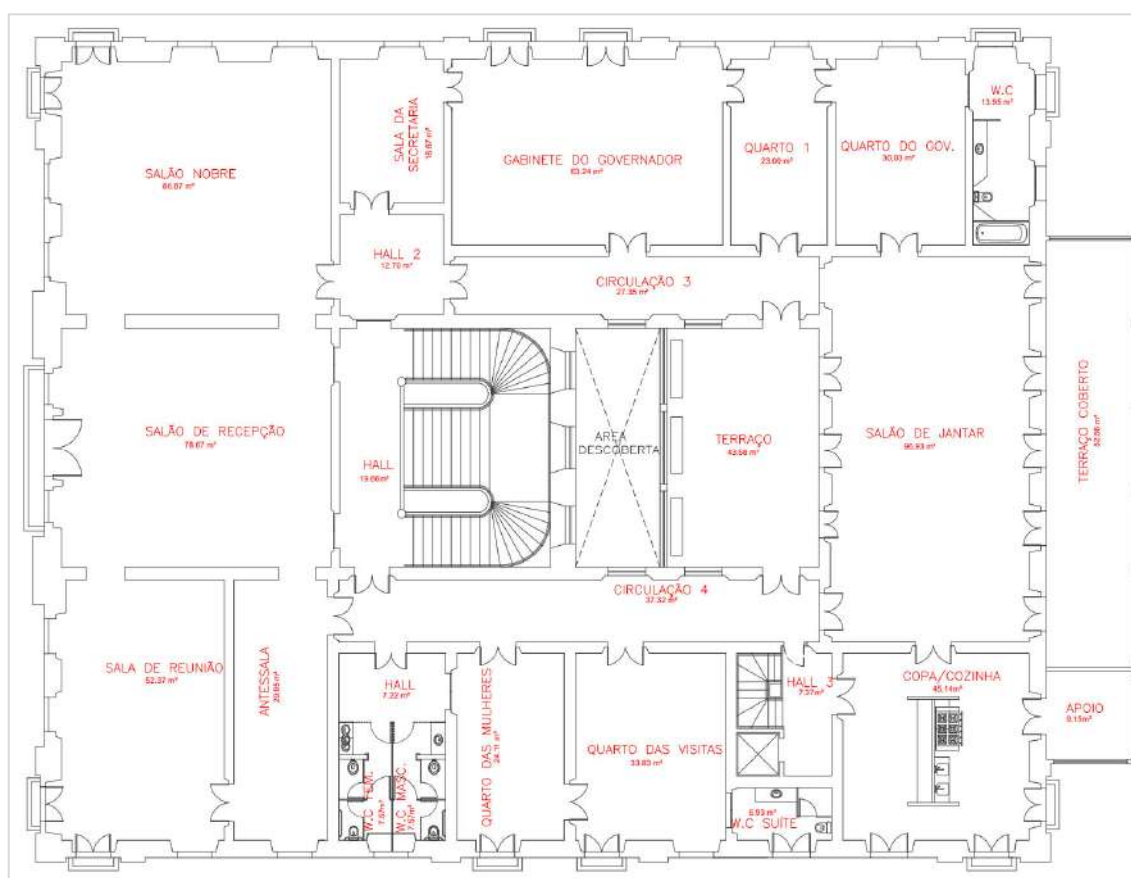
Planta baixa do pavimento superior do Palácio-Museu Olímpio Campos, adaptado do PSCIP prancha 04/04
